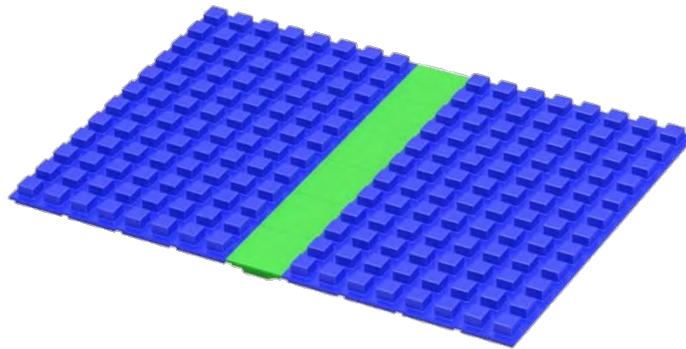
Esquema de uma laje utilizando a forma chocolate (azul). Em verde são os Plasterit (para fazer as vigas).
